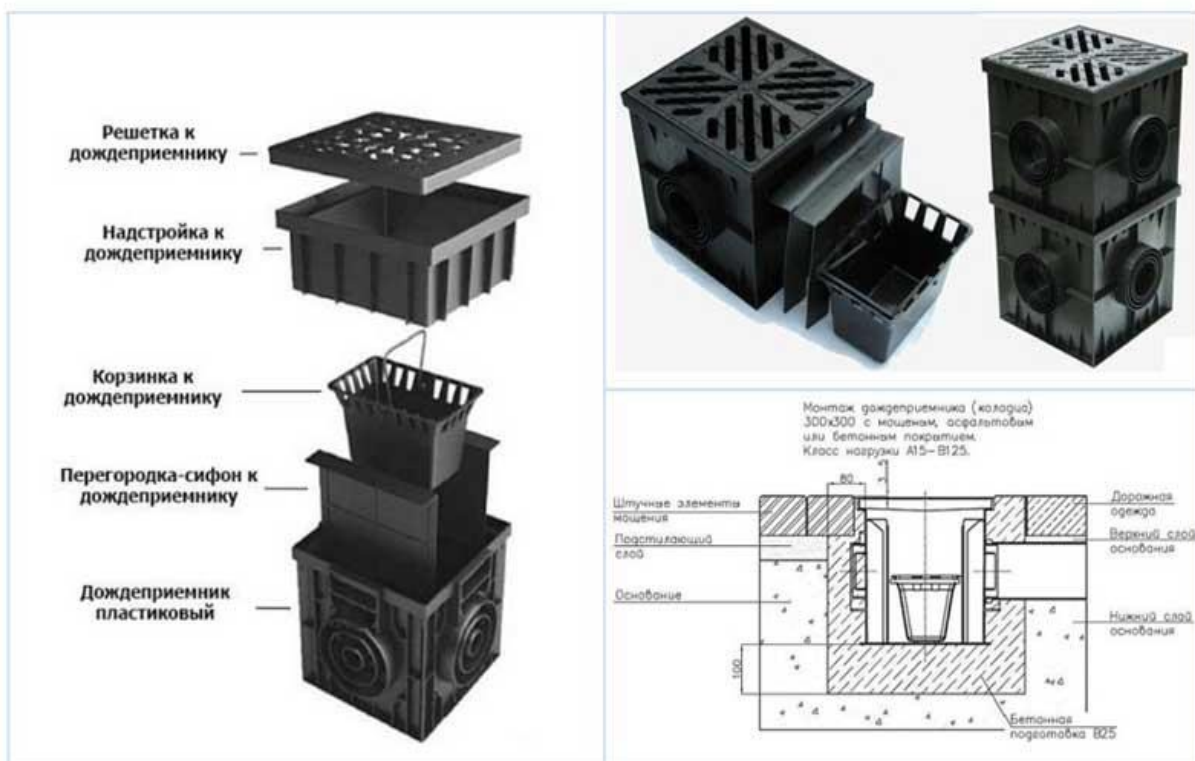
Конструкция и схема установки дождеприёмных колодцев
